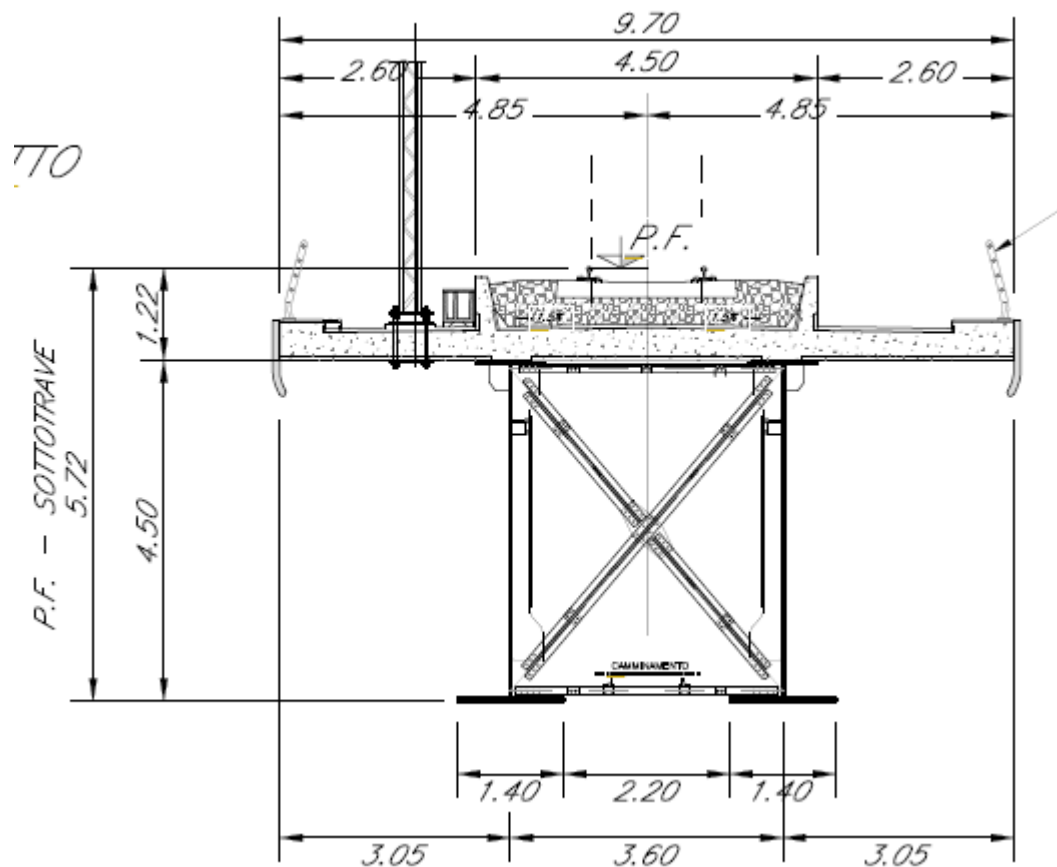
sezione trasversale dell'impalcato misto acc-clc 60m
